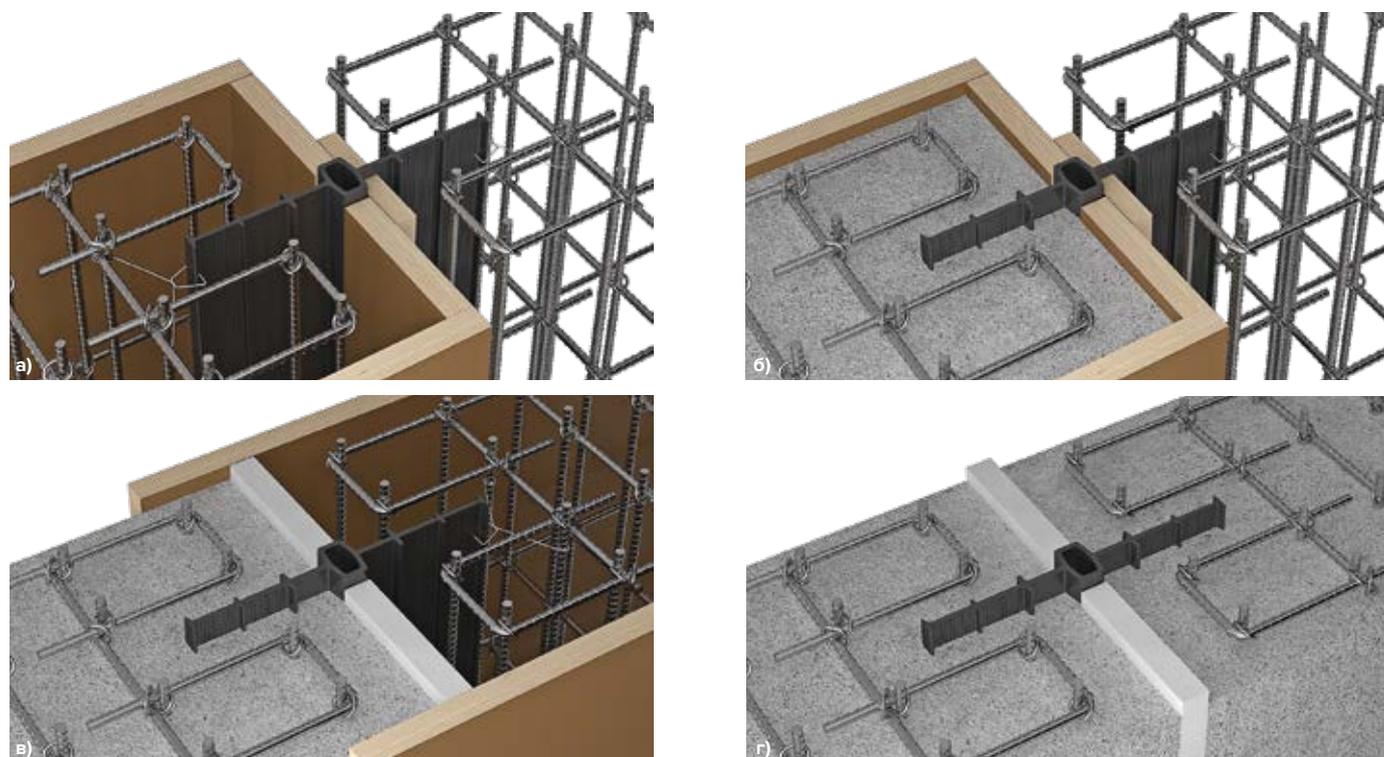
Этапы работ по установке гидрошпонок серии ТН Фундамент ДШВ
